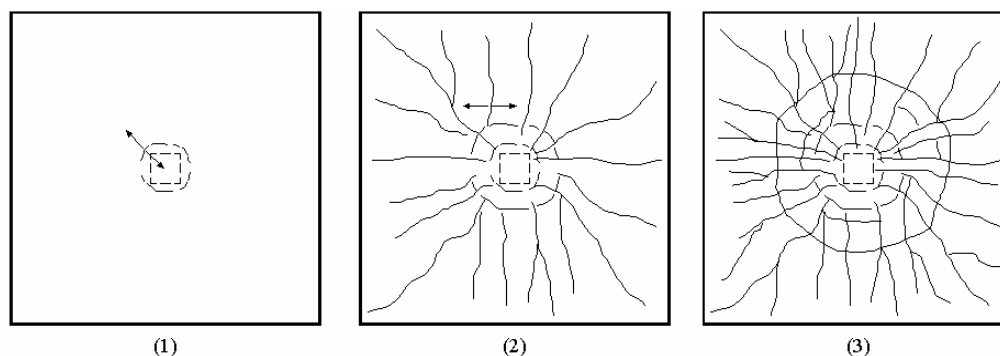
Processo de formação de fissuras de punção. 1: fissura tangencial formada por tensões radiais. 2: fissuras radiais formadas por tensões tangenciais. 3: configuração de ruptura
